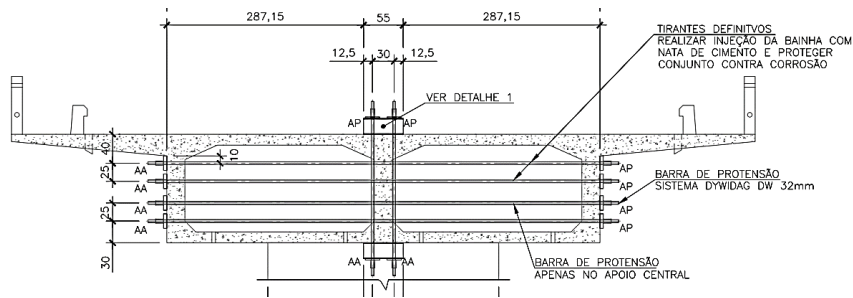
Processo Executivo de Construção para a Elevação dos 5 Viadutos
